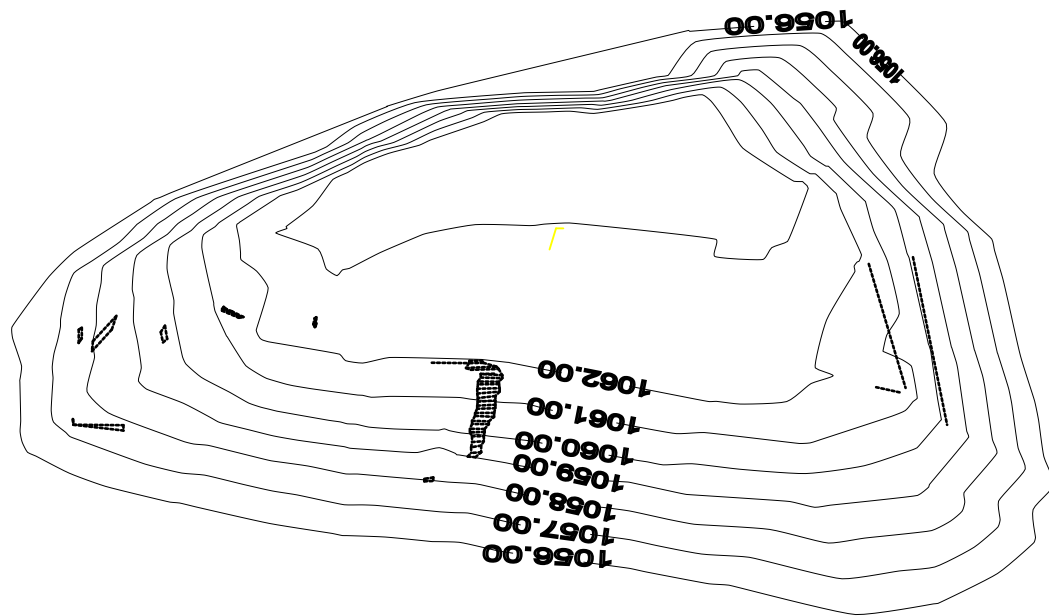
Reconstrucción hipotética de la secuencia constructiva; segunda fase
